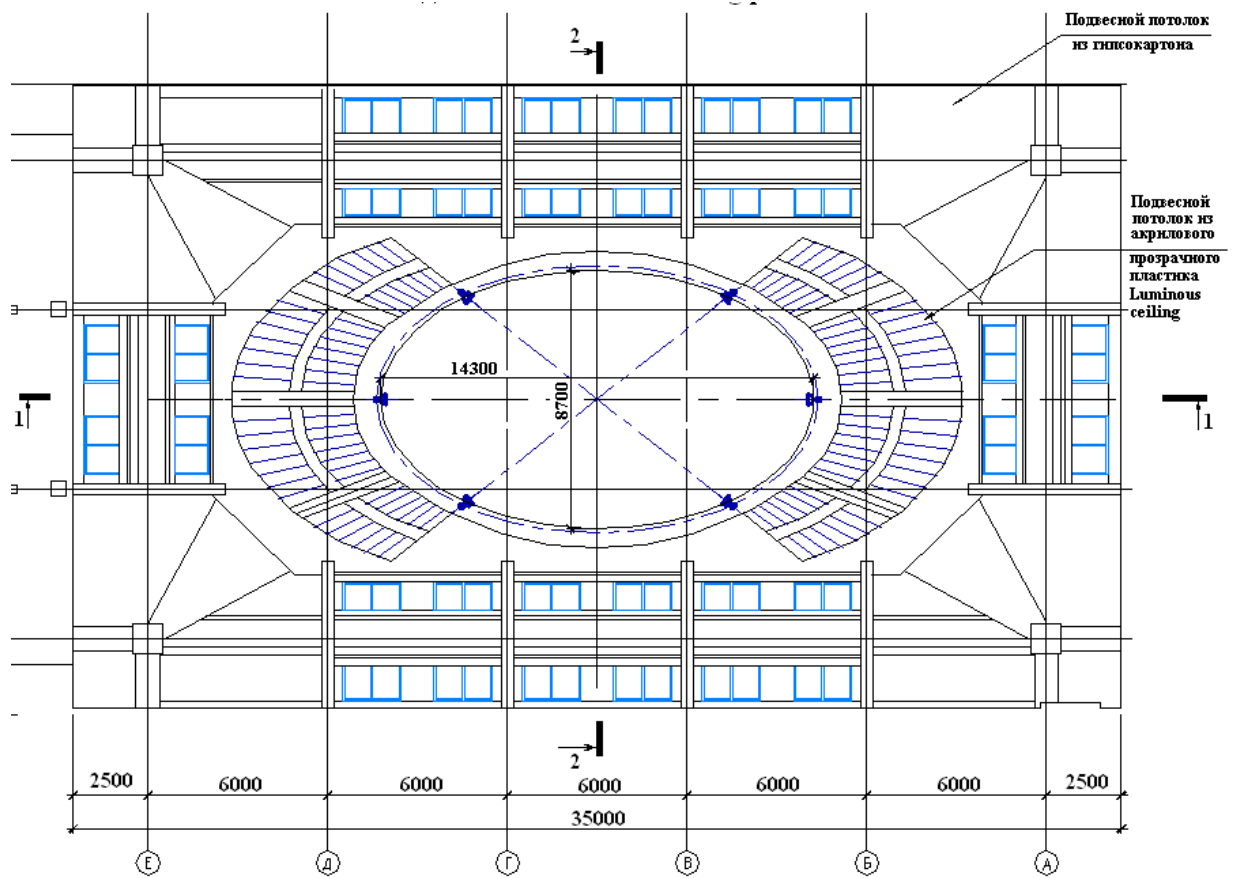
План первого этажа реконструируемой рекреационной зоны ДонНАСА
